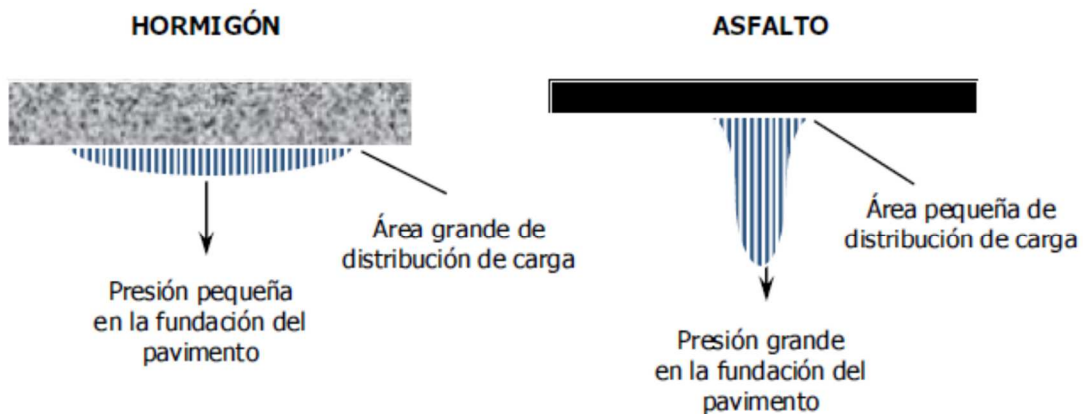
Esquema del comportamiento de pavimentos flexibles y rígidos
